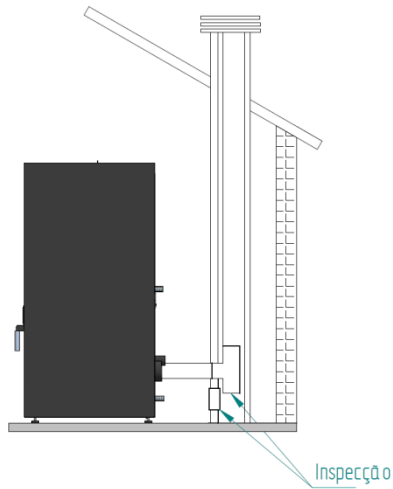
Vista lateral da instalação com chaminé, com exemplo do ponte de inspeção
